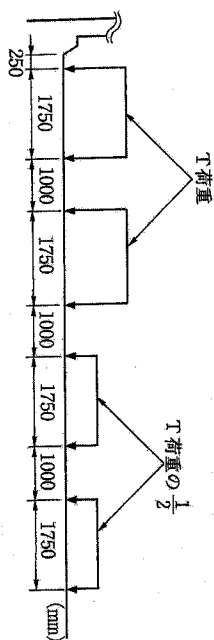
主桁設計時のT荷重の載荷方法
